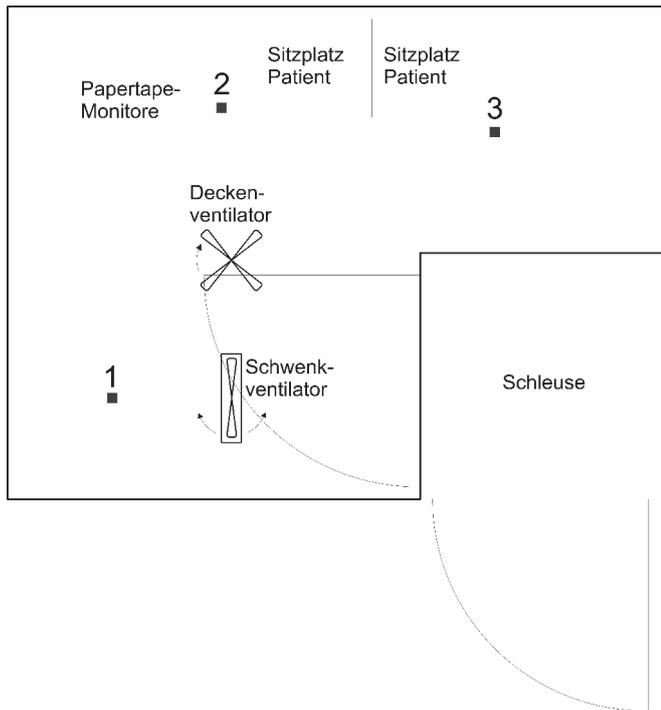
Grundriss des Expositionslabor. 1, 2, 3: Messpunkte.
